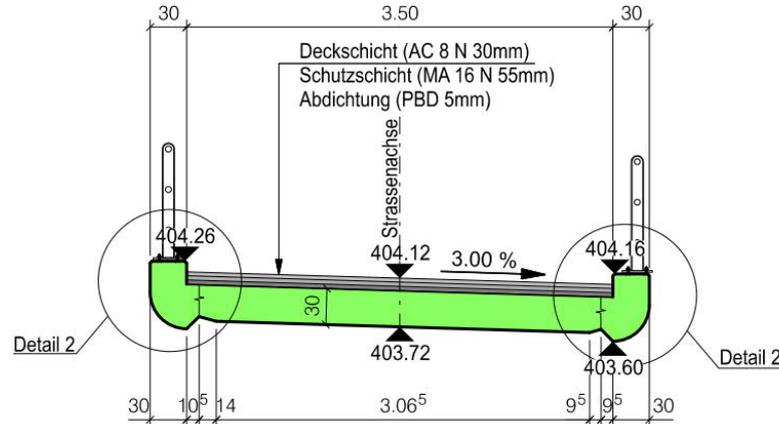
Querschnitt Brücke Littenbachweg, Kübach
